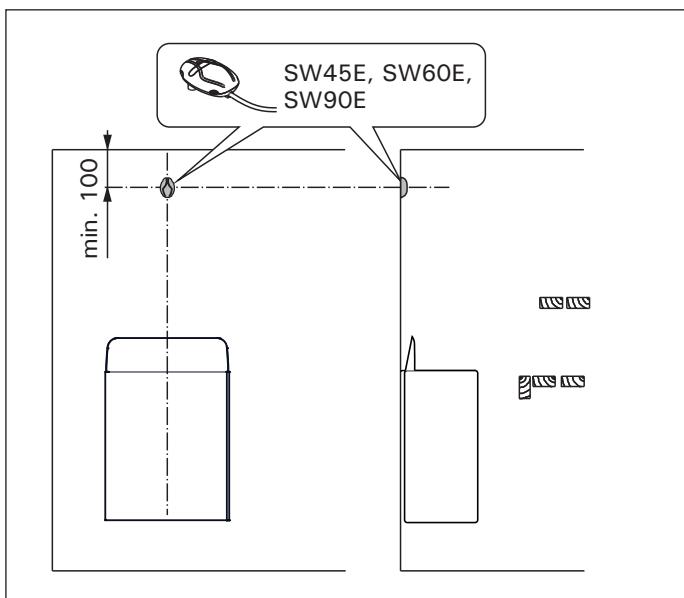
Installation du capteur (toutes les dimensions sont fournies en millimètres)
